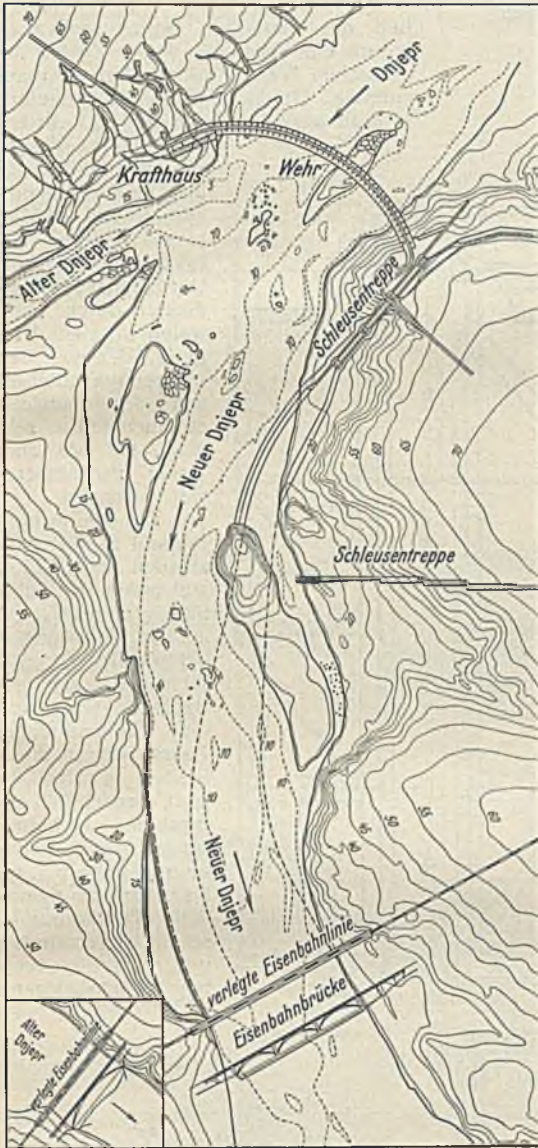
Lageplan der Dnjepr-Wasserkraftanlage.
